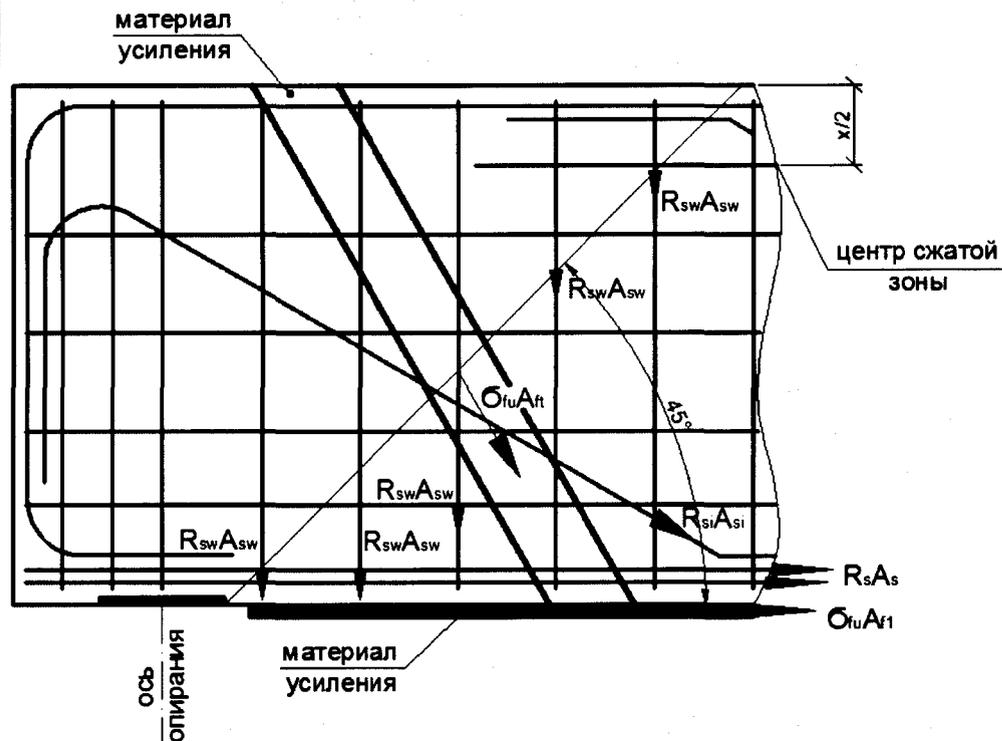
Расчетная схема к определению несущей способности наклонного сечения на действие поперечной силы
